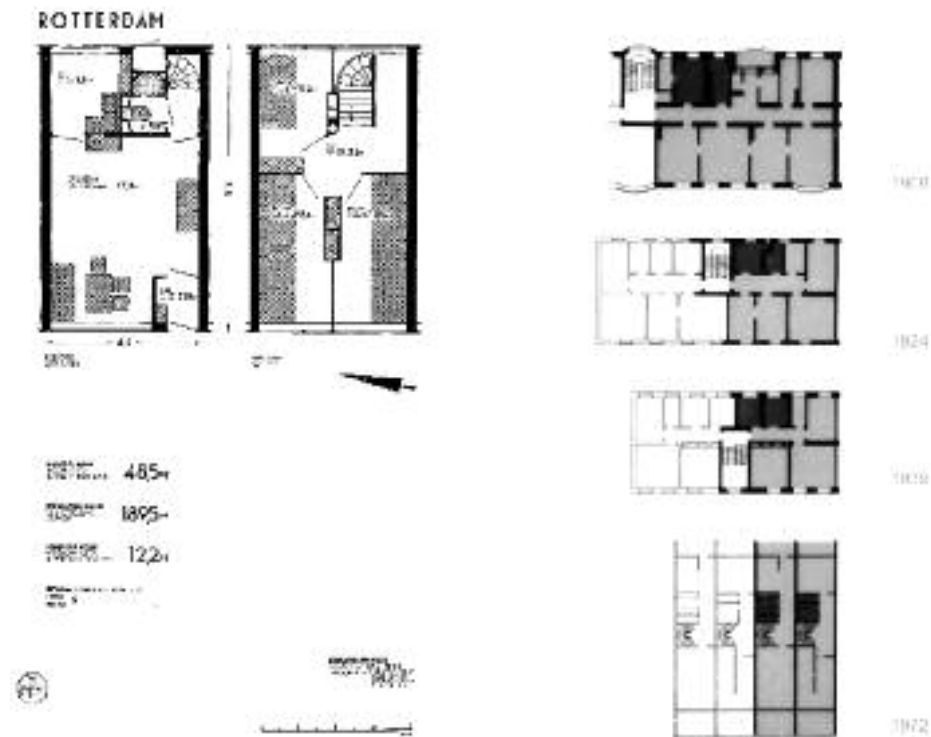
oben links: Grundriss J. J. Oud, Entwurf für ein Einfamilienhaus mit 48,5 Quadratmetern Grundfläche
